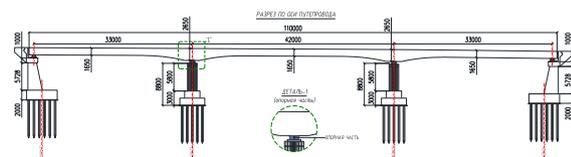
Фасад монолитного железобетонного путепровода в Самарканде
